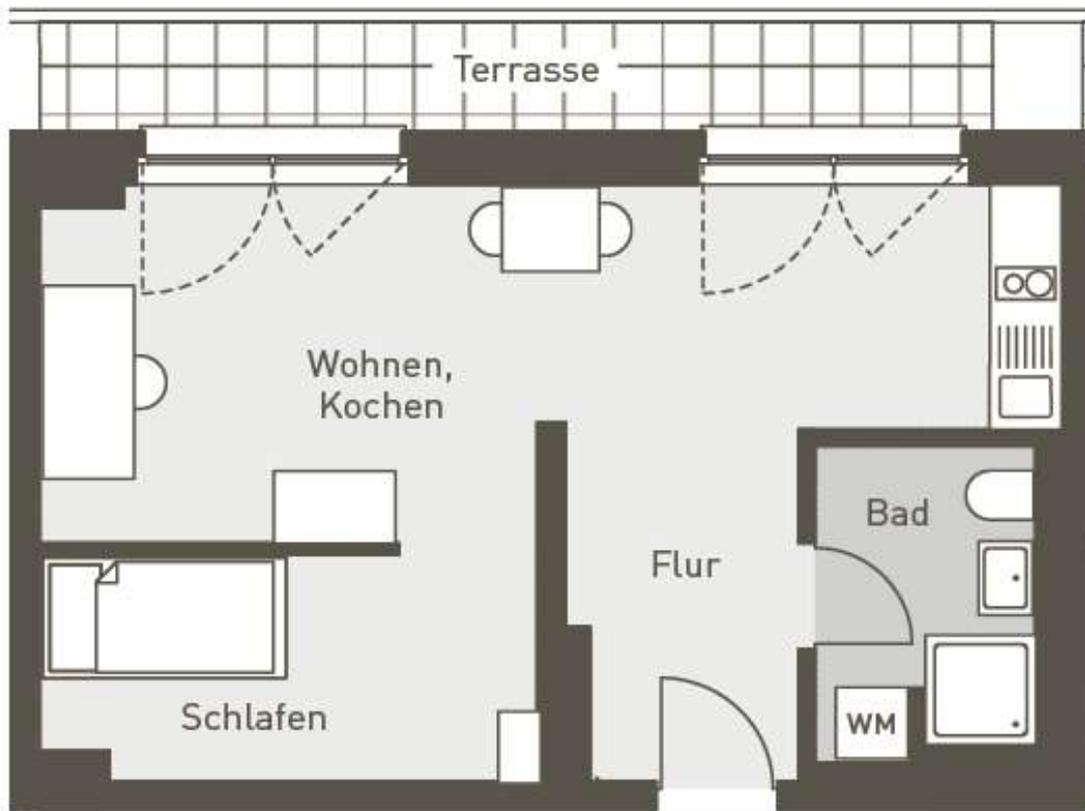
Grundriss 1,5 Zimmer Dachgeschoss mit Dachterrasse, 43 qm (© PROJECT)
